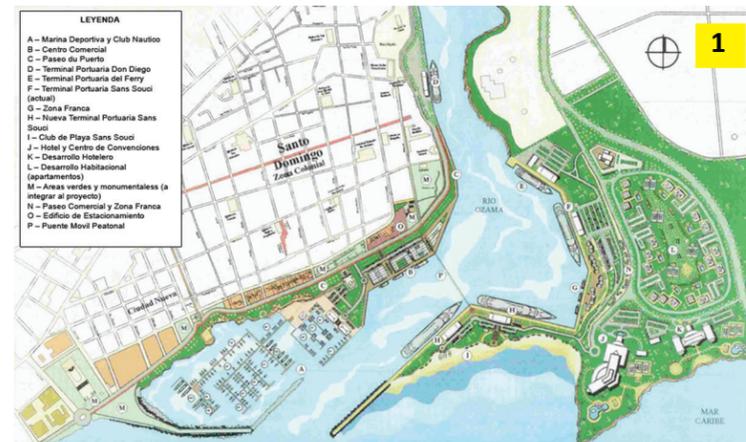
Plano de conjunto Proyecto Sansouci, arq. Alejandro Marranzini - Estudio de arquitectura Orbitarq (Revista digital Arquitecto, ciudad - teoría y crítica Abril 2011).
